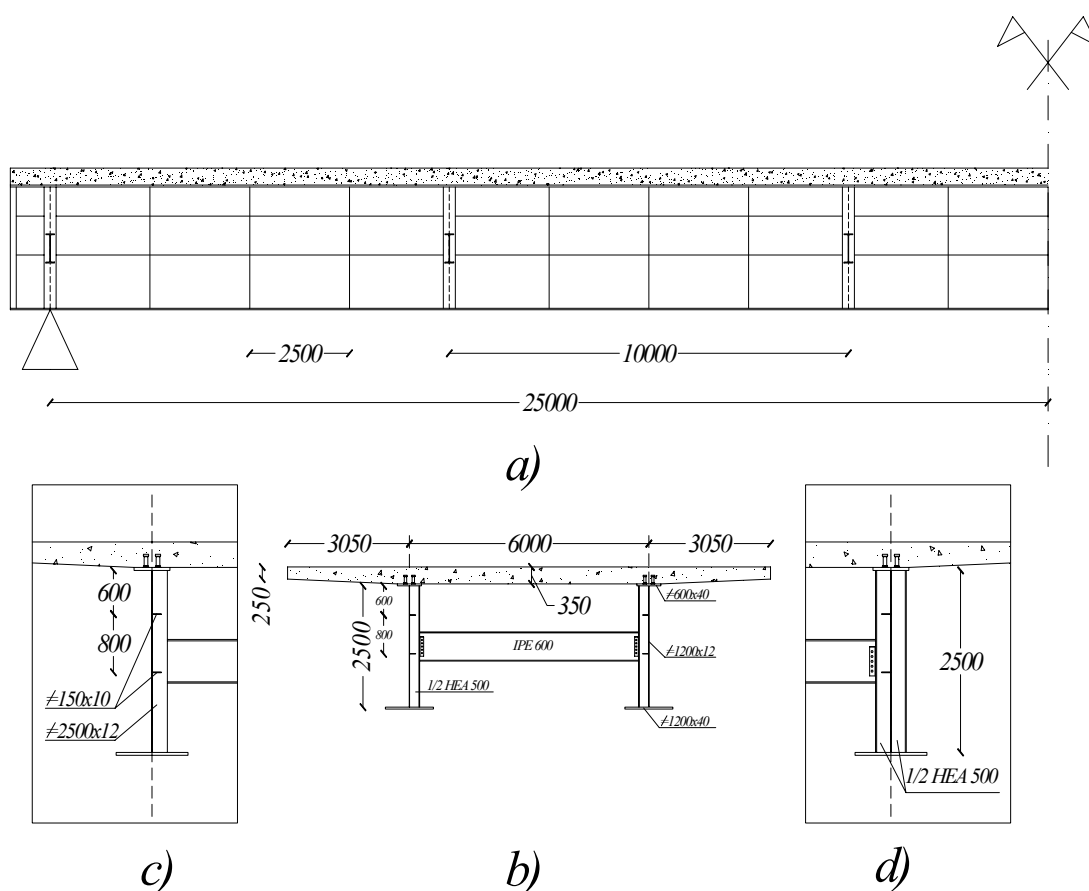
Impalcato da ponte in acciaio calcestruzzo: a) sezione longitudinale b) sezione trasversale su un trasverso c) sezione trasversale corrente d) sezione trasversale sull'appoggio
